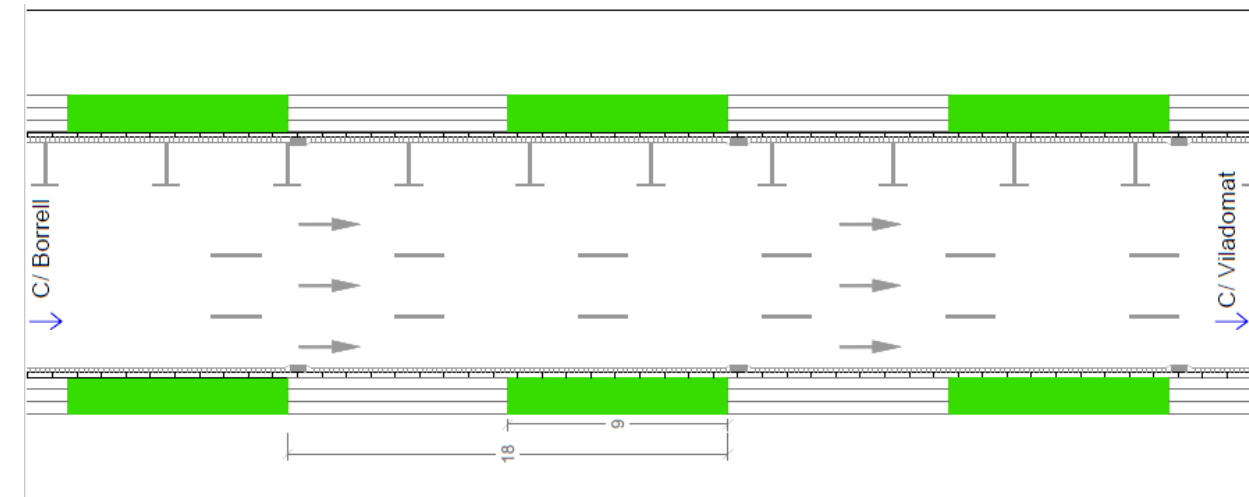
Planta de la propuesta para la C/ Mallorca, caso a) (Tipo 2).
